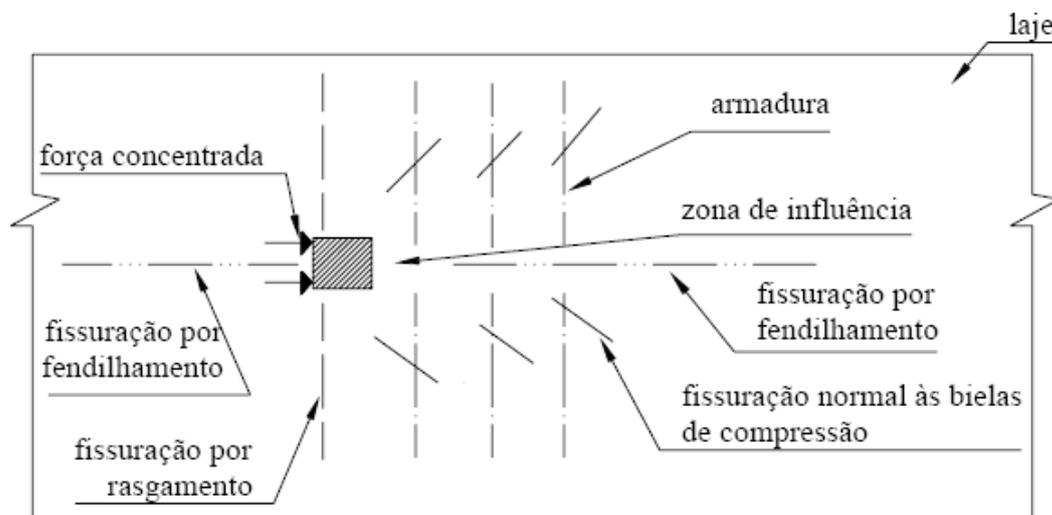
Tipos de fissuração na laje, Kotinda (2006)
